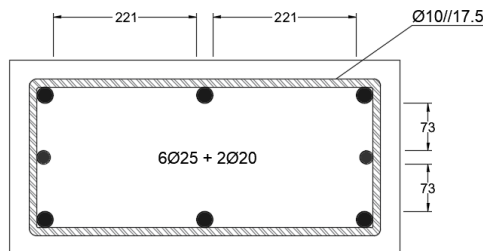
Armadura longitudinal e transversal do P2 reforçado.
